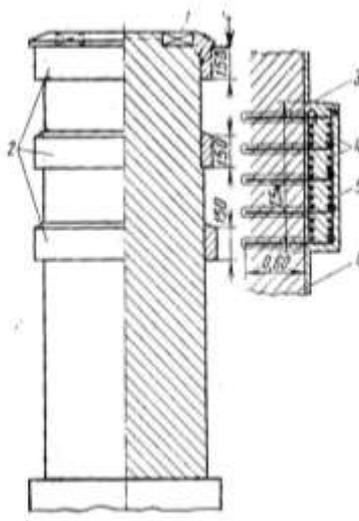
Усиление промежуточной опоры железобетонными поясами:
